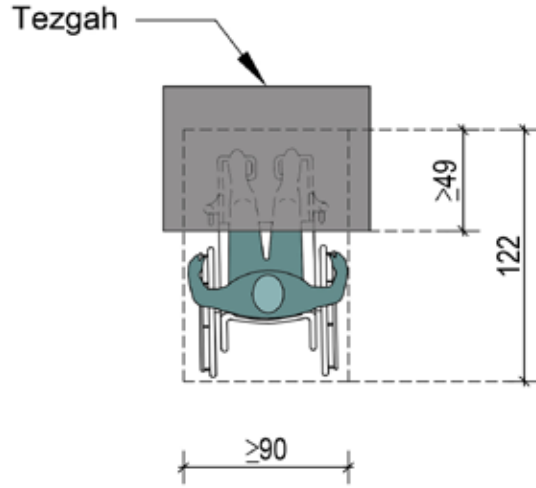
Farklı Mutfak Planları ve Gerekli Ölçüler
